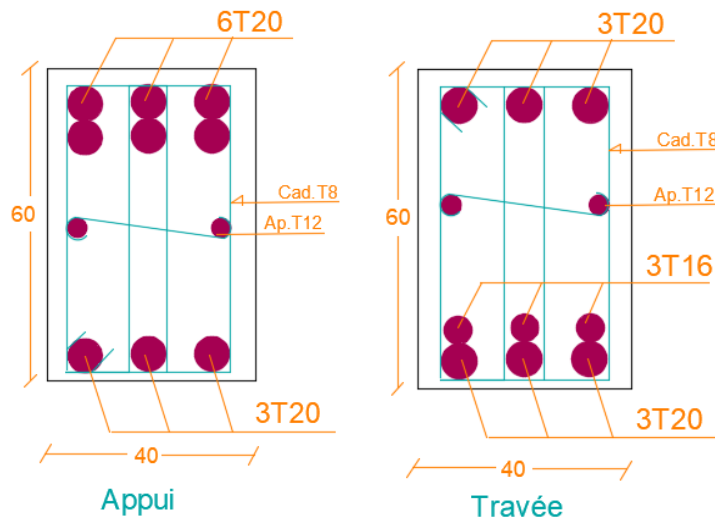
Ferrailage Des Poutres Porteuses Axes (A-B-E) Des étages courants.
